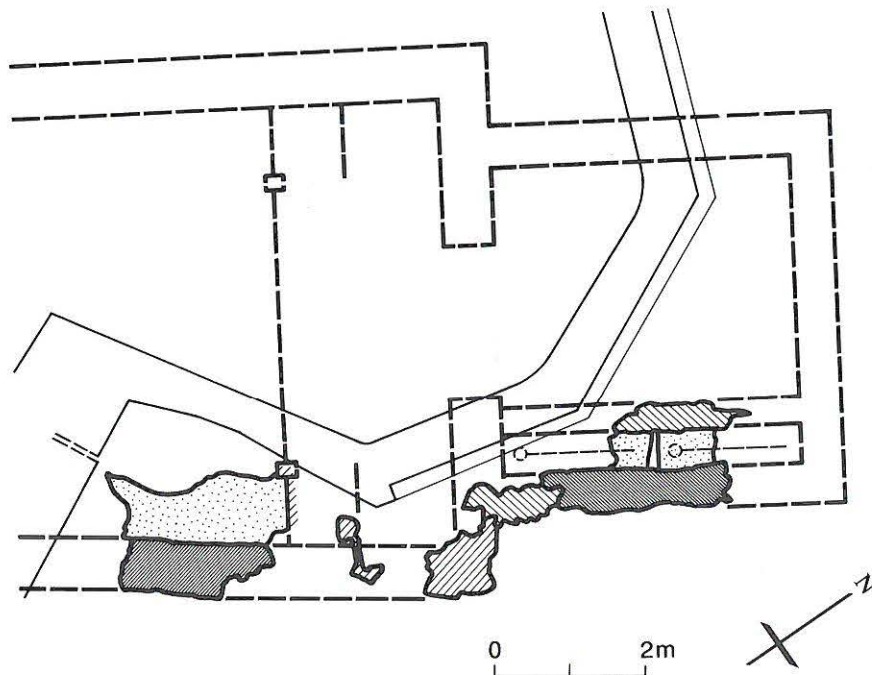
Zusammenfassung der Elemente von Grabkammer und Westanbau in einen Kirchengrundriss. Hypothetische Rekonstruktion. M. 1:100.
